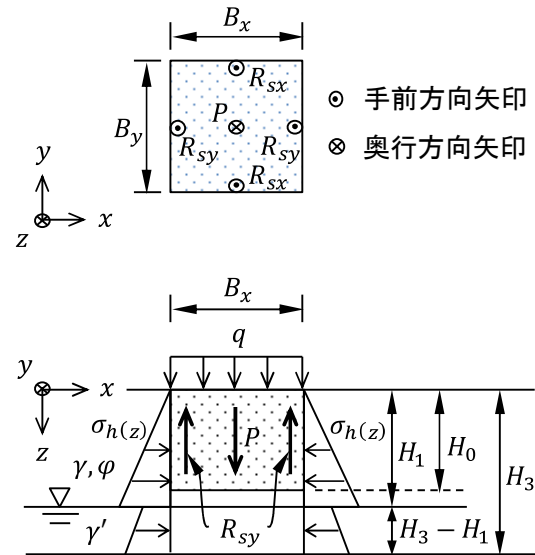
地震時支持力計算の概念図(上: 平面図, 下: 正面図)
